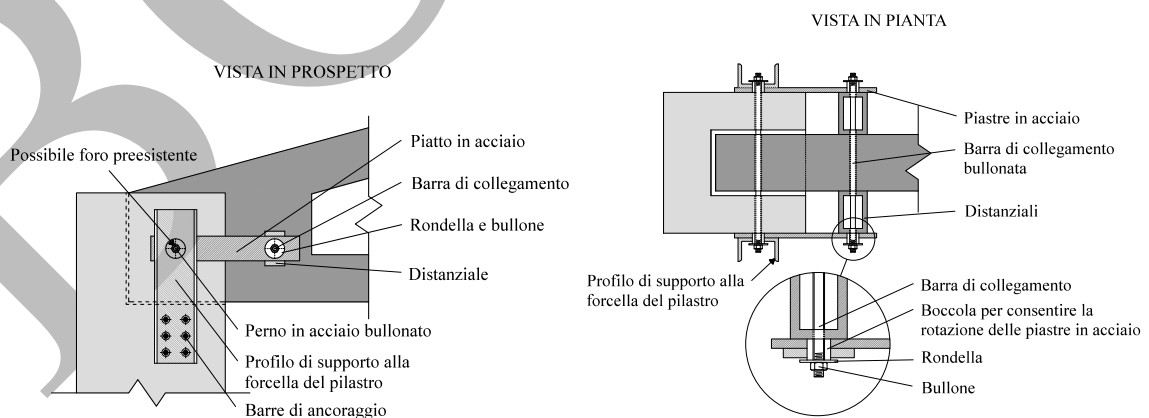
Intervento su connessione trave-pilastro mediante perni e piastre in acciaio
